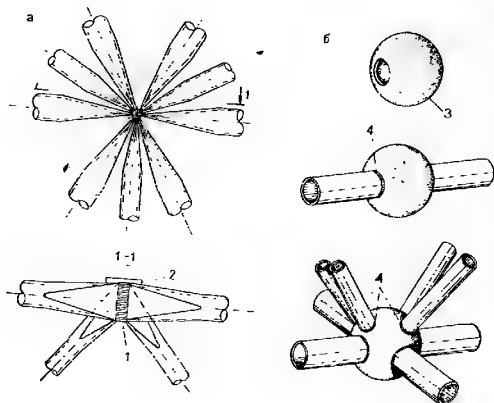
Примеры сварных узлов стержневых плит
